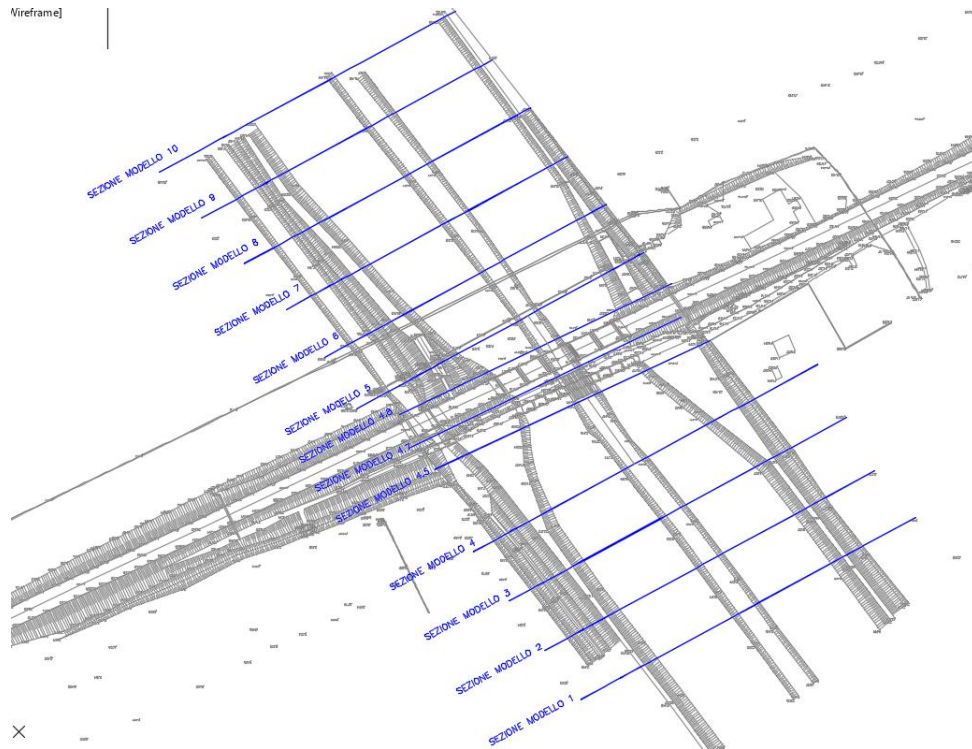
posizione planimetrica delle sezioni utilizzate nell'implementazione del modello idraulico (ante operam)
